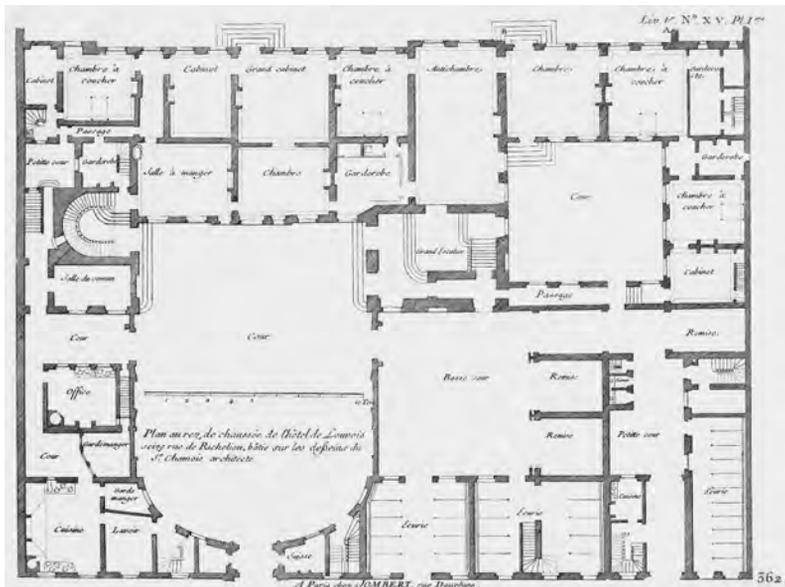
Paris, Hôtel de Louvois, Grundriss, Erdgeschoss
